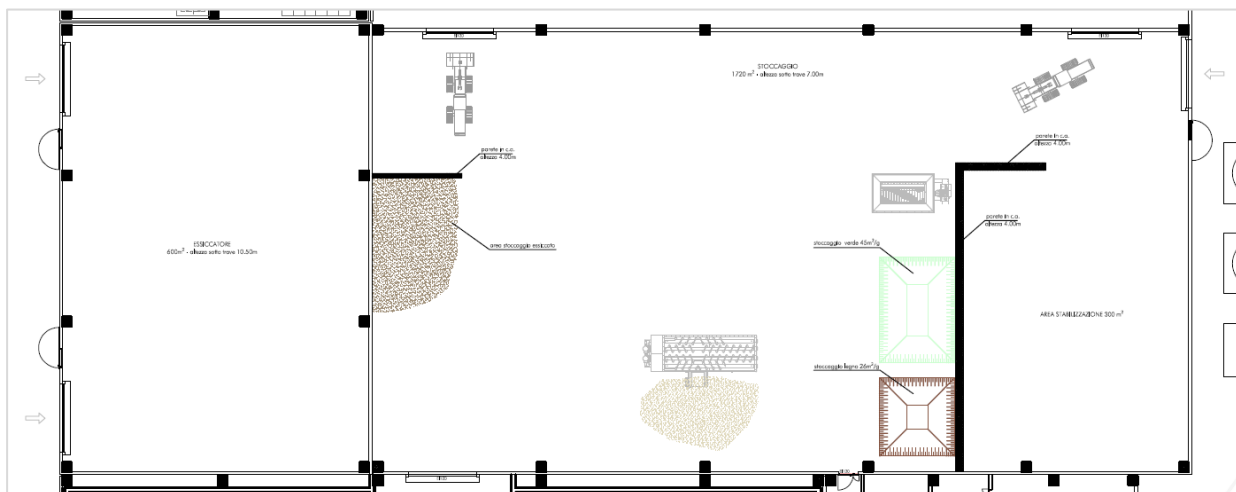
Capannone in cui avviene la disidratazione e l'essiccazione (a sinistra) e capannone maturazione (a destra)_ Stralcio dalla planimetria generale
